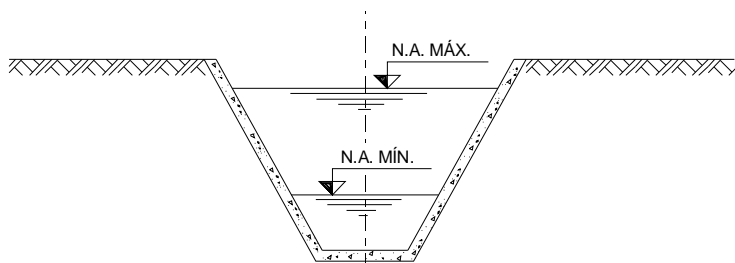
Canal em concreto – Seção trapezoidal com base reduzida.
